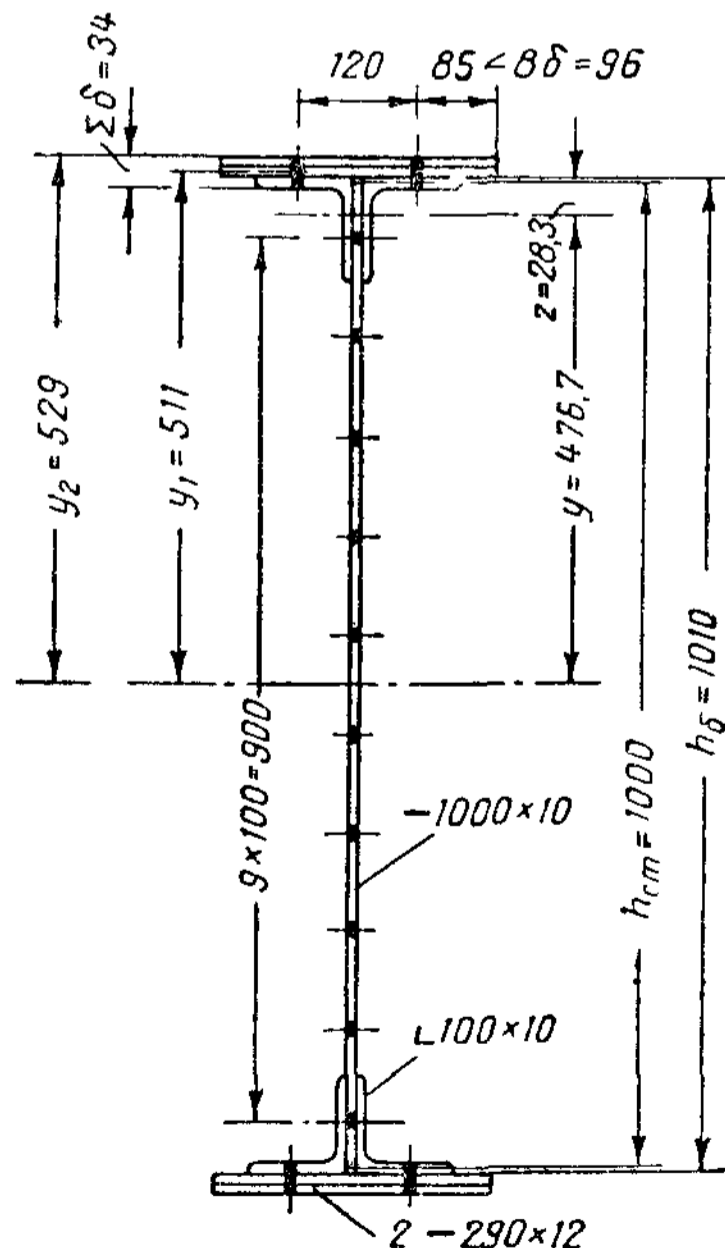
Сечение клепаной балки (к примеру VIII.1)
